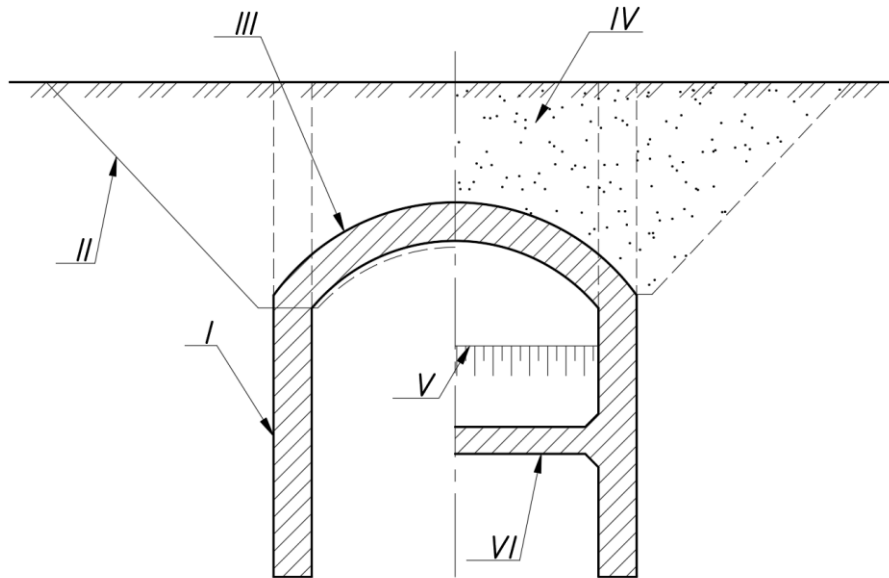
Этапы строительства тоннеля полуоткрытым способом: I – возведение стен тоннеля; II – разработка котлована до низа перекрытия; III – возведение свода; IV – обратная засыпка и восстановление поверхностных условий; V – разработка грунтового ядра
